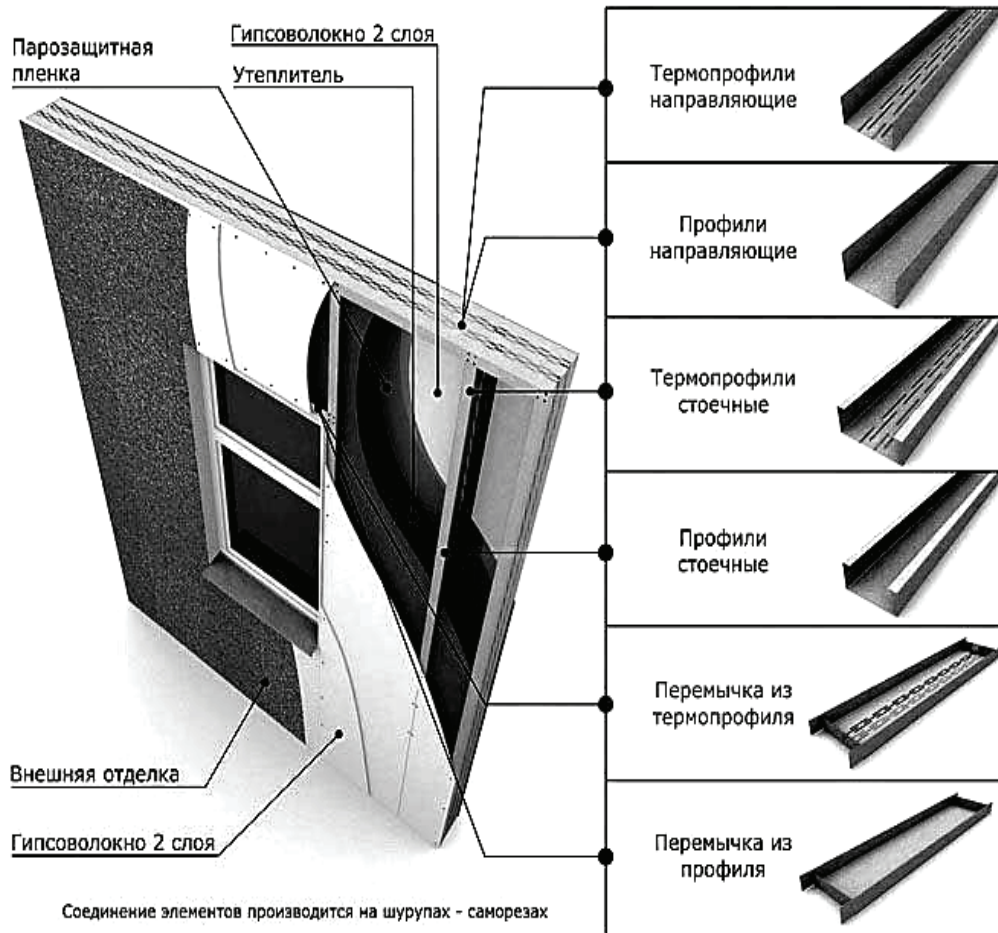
Схема конструкции стеновой панели при возведении зданий ЛСТК.
